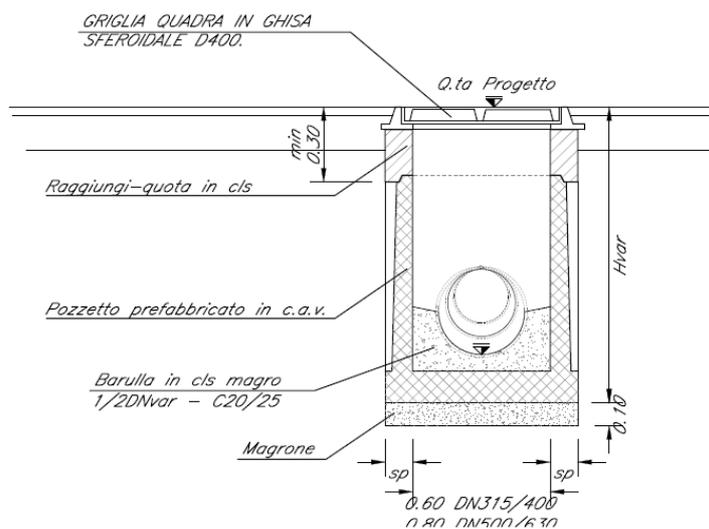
Drenaggio stradale – Sezione pozzetto grigliato
